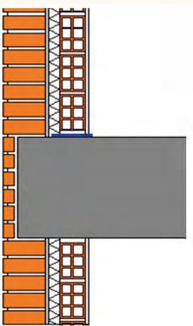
Evolución de las fachadas de ladrillo cara vista: Fachada confinada.
